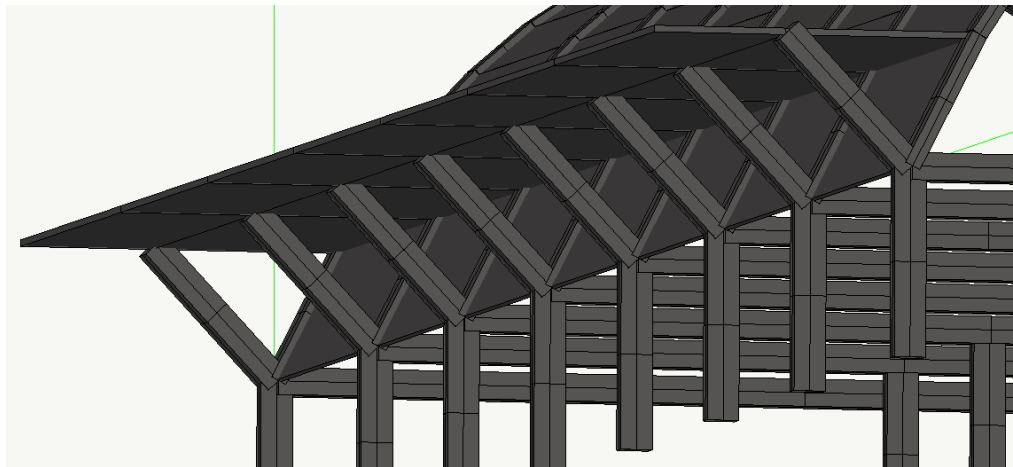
Particolare del Modello 1 in cui è evidente l'assenza della trave che collega la testa dei pilastri.
